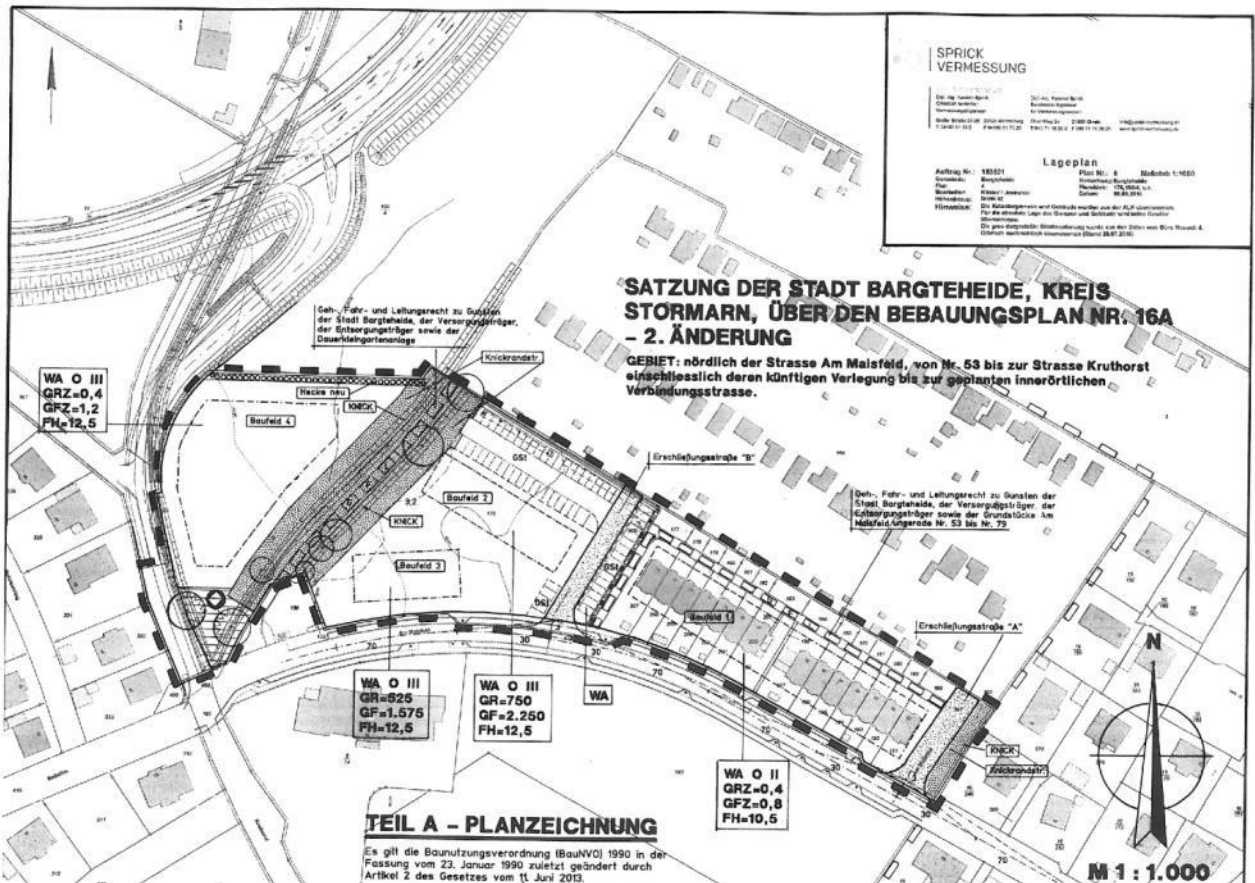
Entwurf der Planzeichnung mit Stand vom Mai 2017 (Quelle: STADT BARGTEHEIDE / SPRICK-VERMESSUNG)
